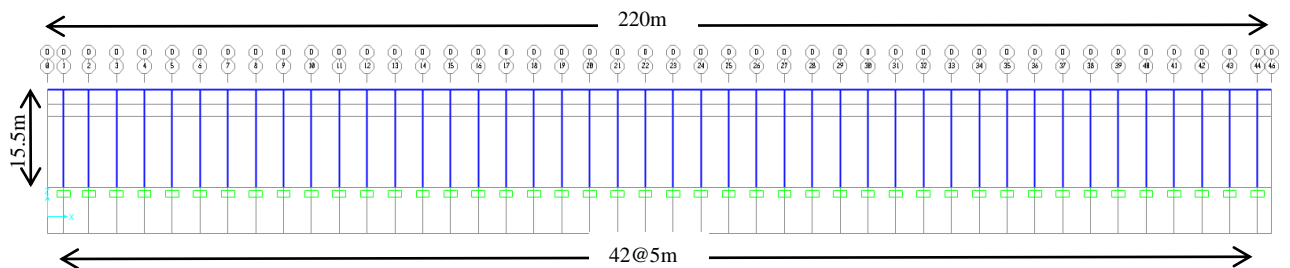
Vista en elevación del plano D de geometría, paralelo a plano X-Vertical.
